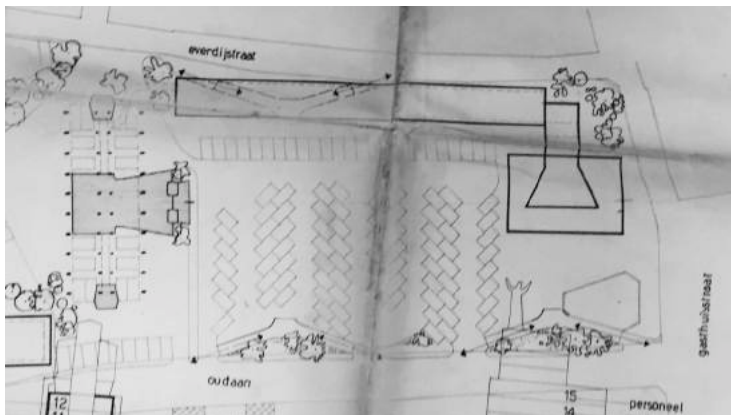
Maquette oorspronkelijk plan. (AAM)
